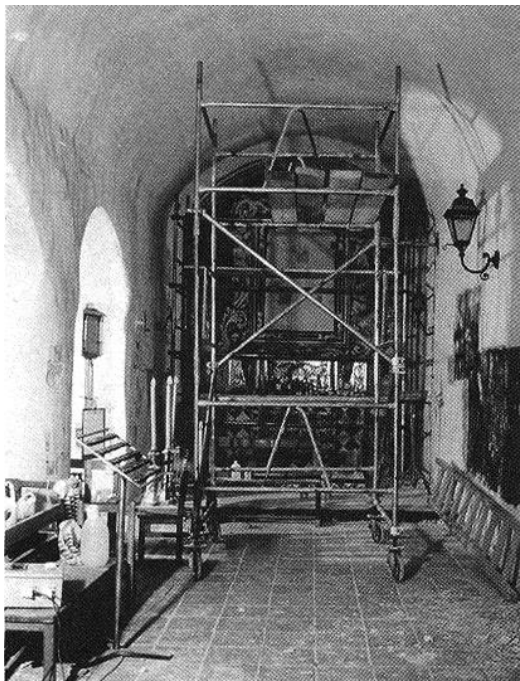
Aspecto interior de la Ermita, con andamio para trabajos de restauración.
